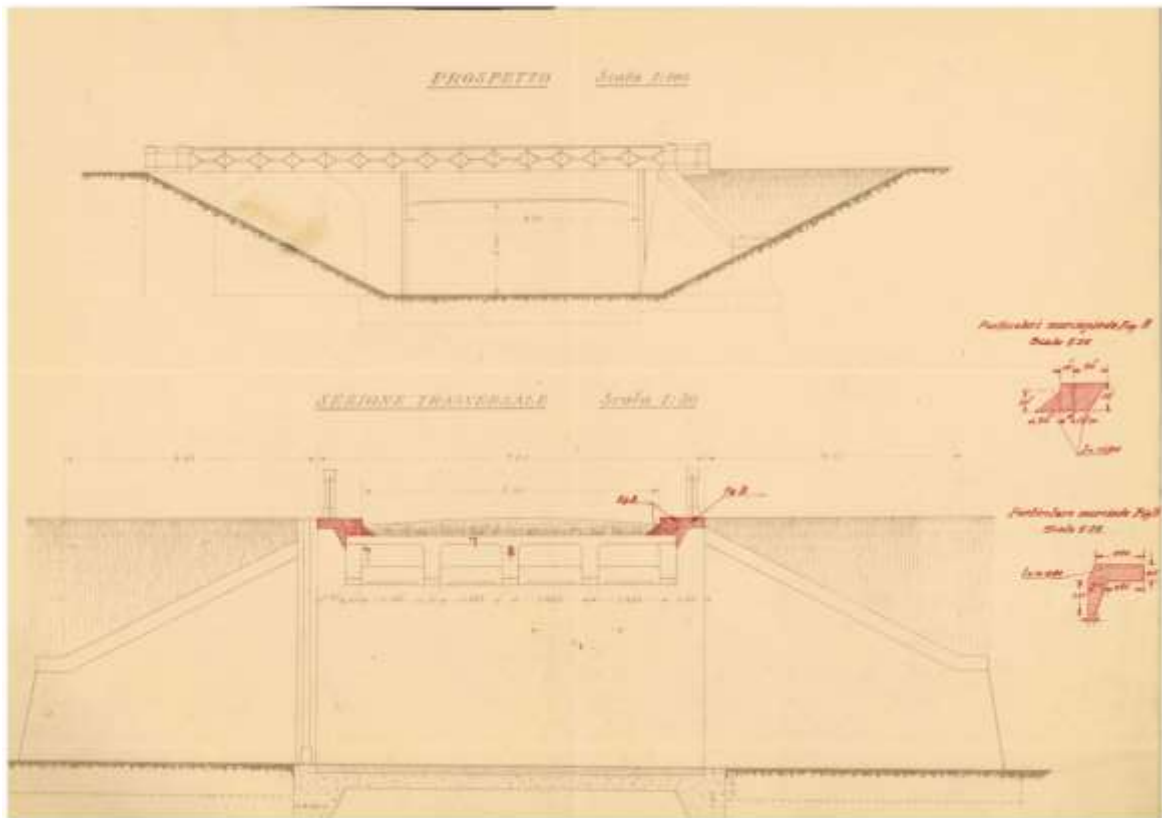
Elaborato grafico – Prospetto, Sezione trasversale
